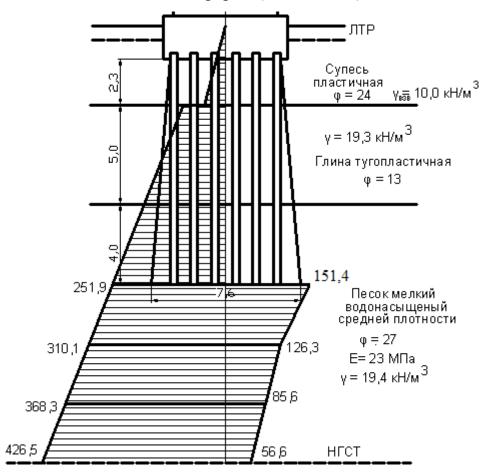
Расчетная схема для определения осадки свайного фундамента
